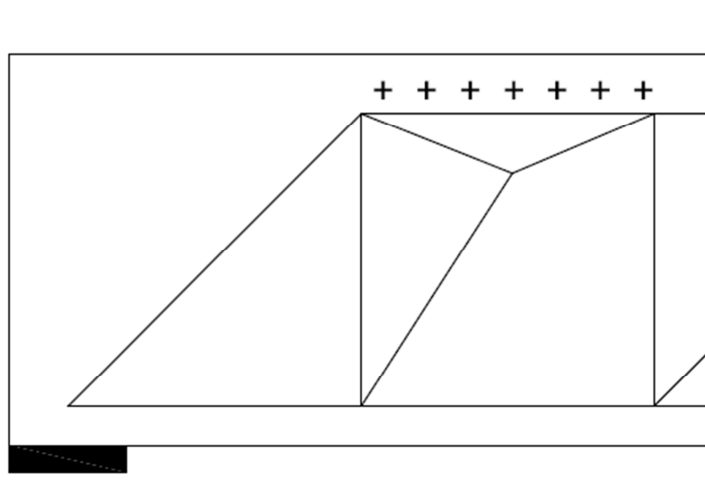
Tracções no elemento horizontal superior do painel da abertura.
